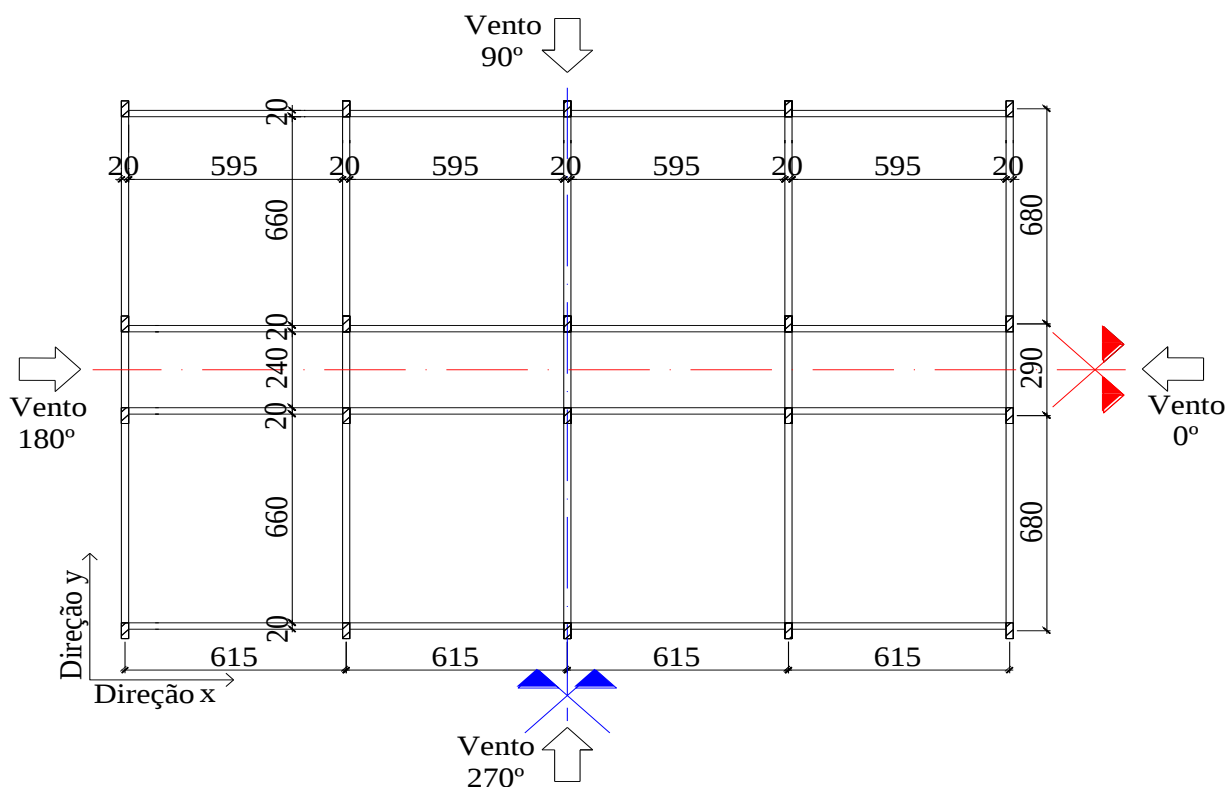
Corte esquemático estudo (dimensões em metros, sem escala)
